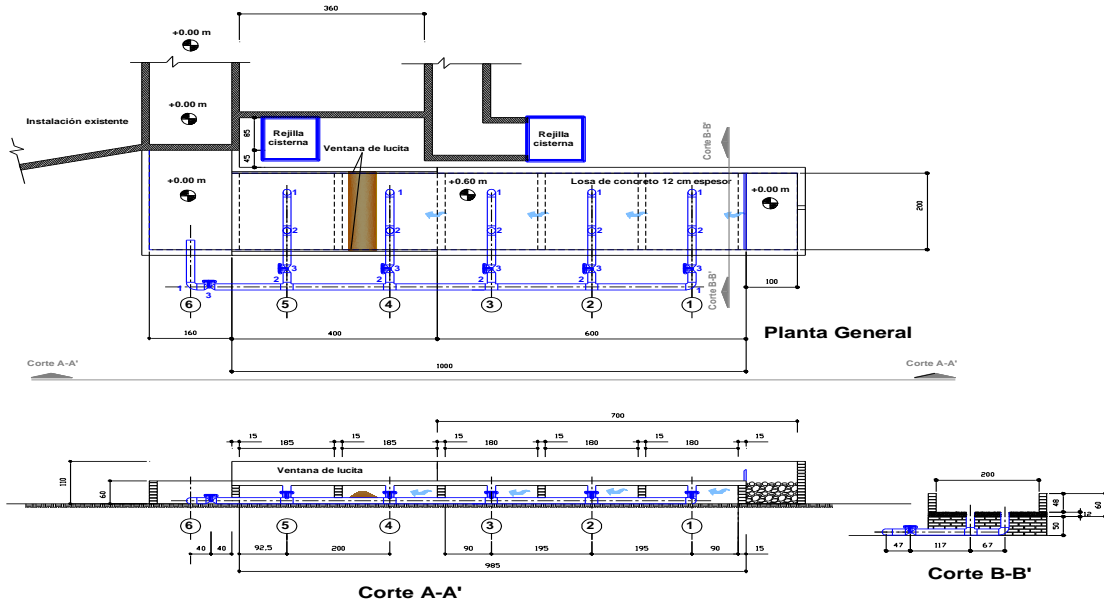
Planta arquitectónica y cortes transversal y longitudinal del canal (Inst. Ing. UNAM.)
